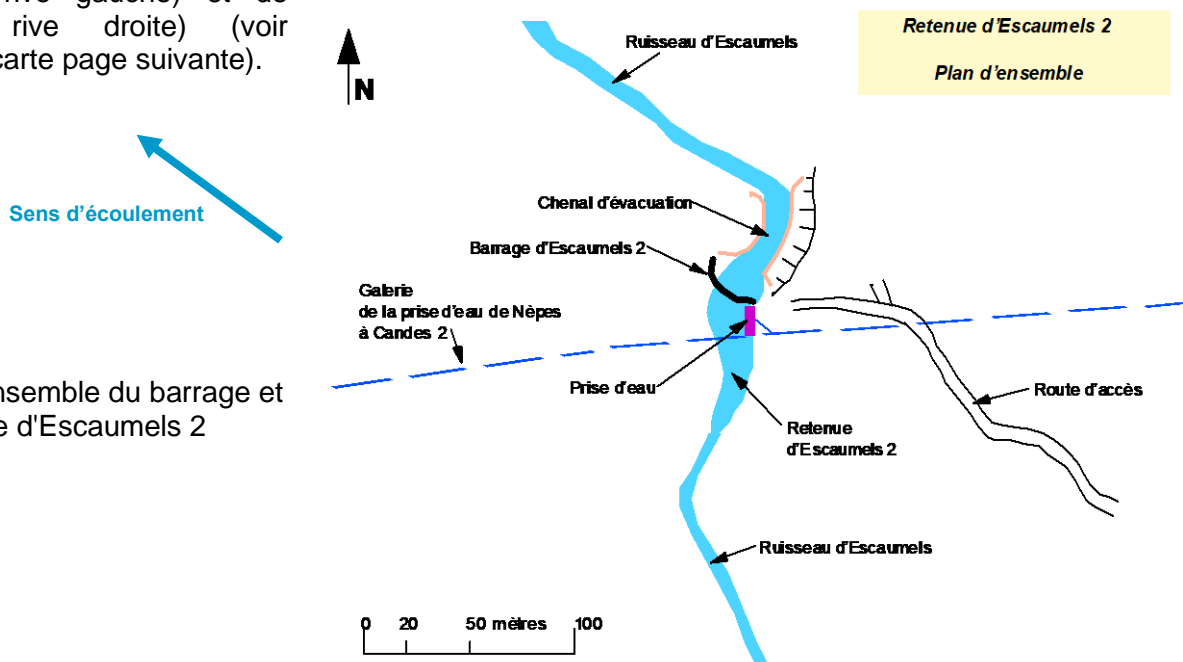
Plan d'ensemble du barrage et de la retenue d'Escaumels 2
